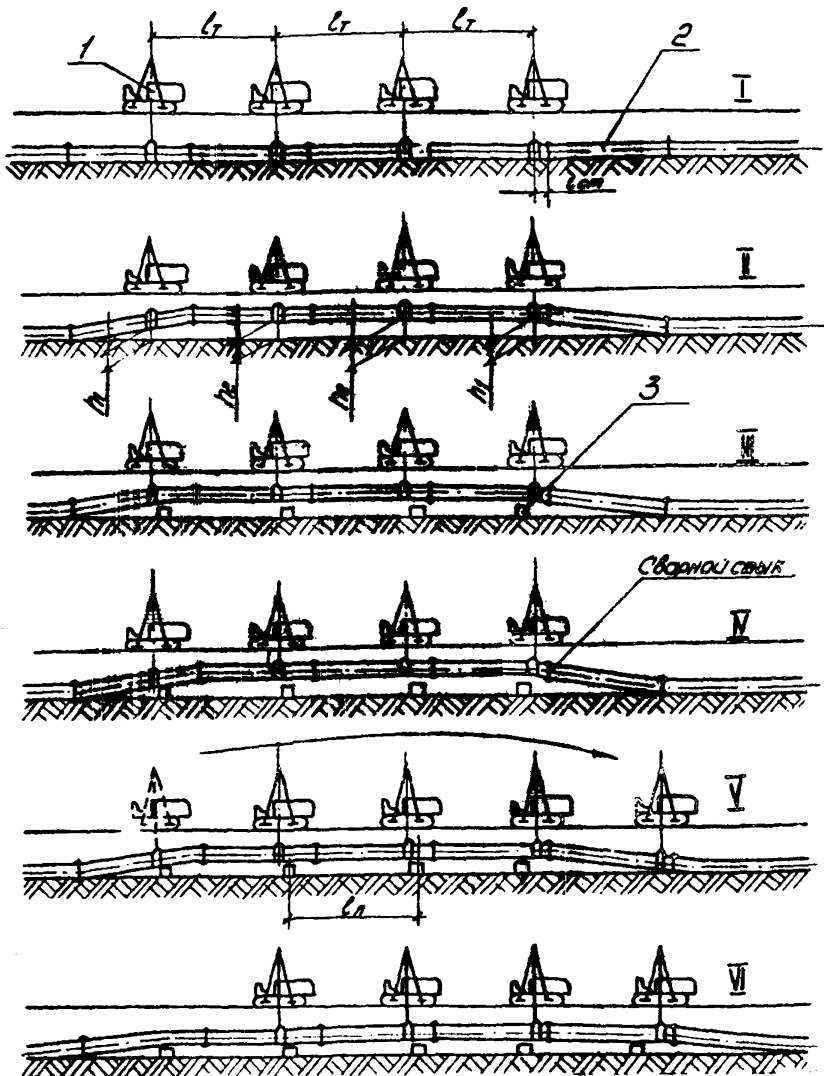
Схема подъема и укладки трубопровода на лежки с переходом одного трубоукладчика.
